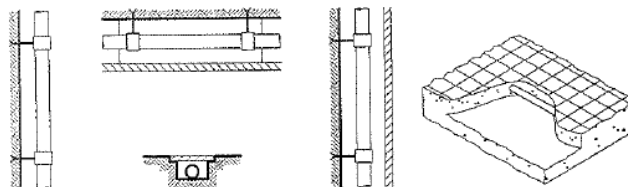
Tipos de instalação de ramais de descarga (4)
